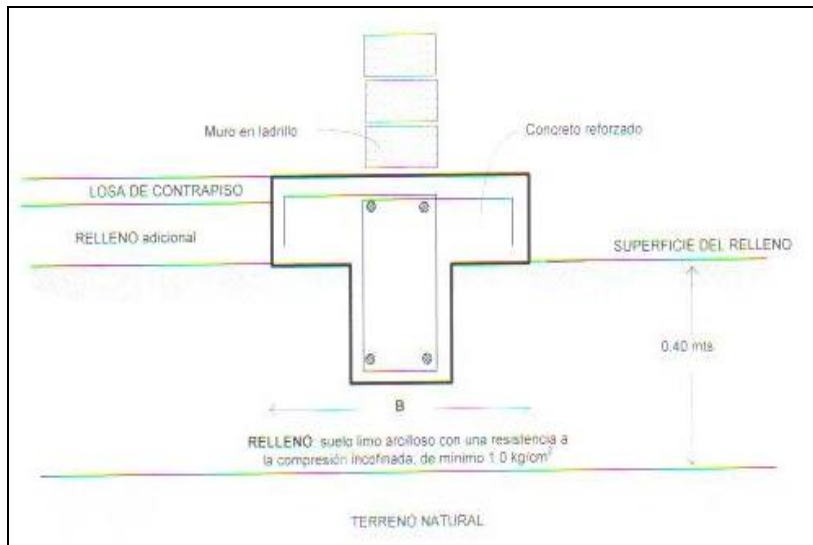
Detalle de zapata corrida para las viviendas de la urbanización Calatrava.
